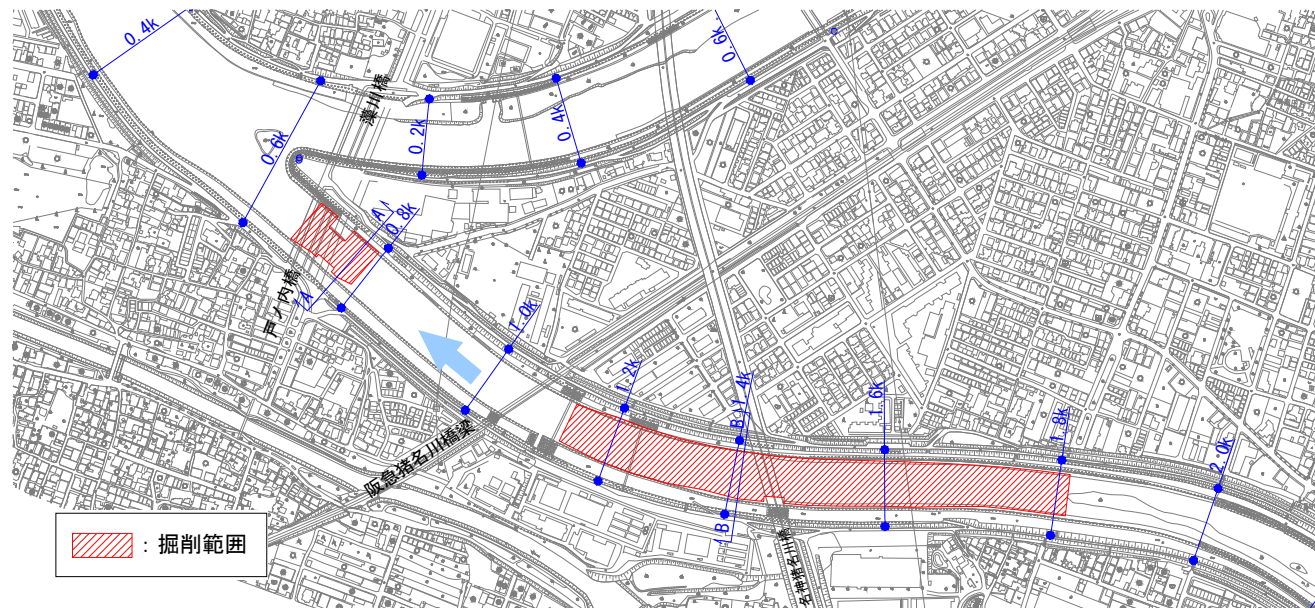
戸ノ内(H25 工事)地区 平面図
